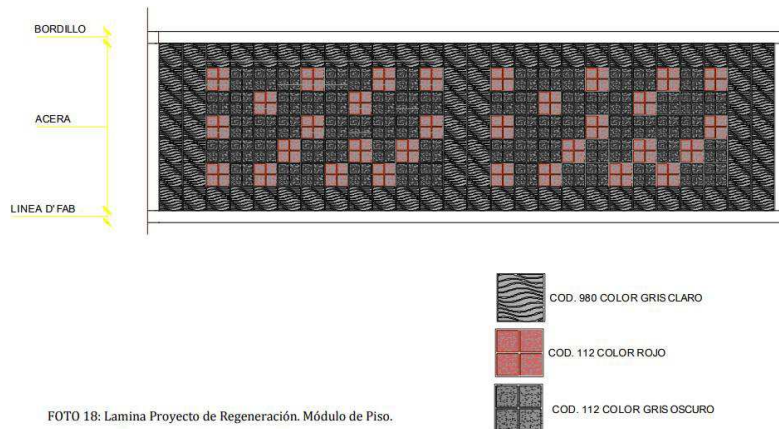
Lamina Proyecto de Regeneración. Módulo de Piso.
